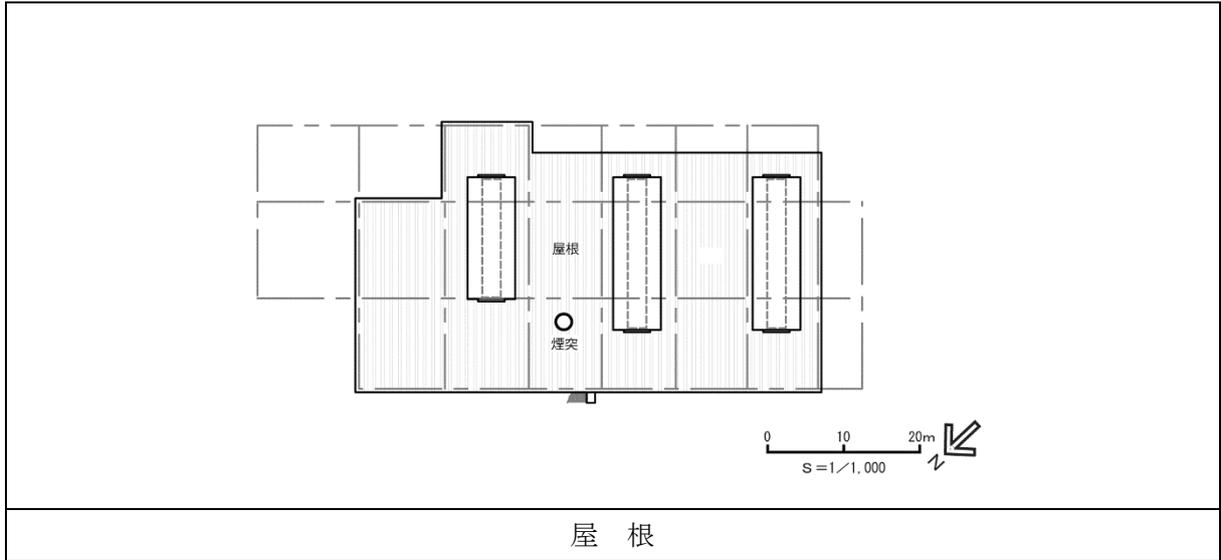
(9) 各階平面図 (計画施設：Ⅱ期)
